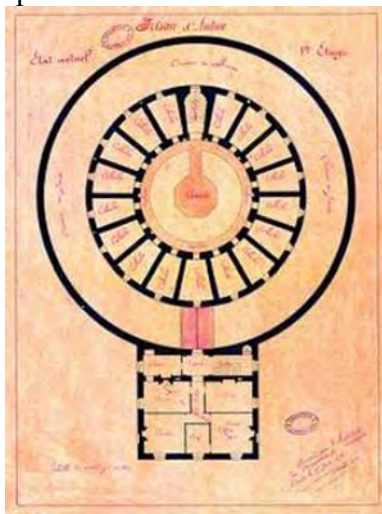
Plan de la prison d'Autun (AD71, 4N)
